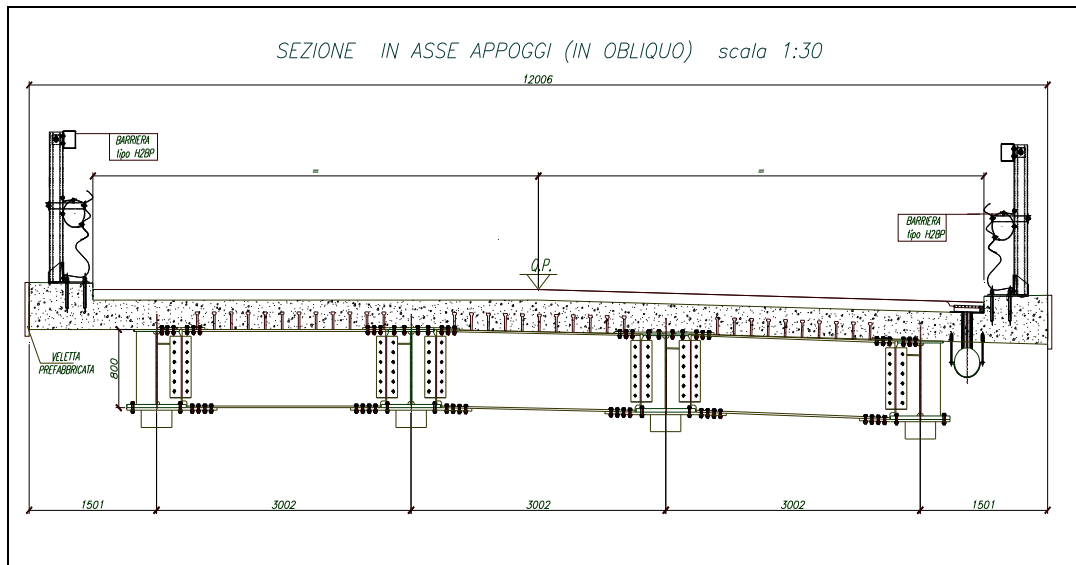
Sezione tipo dell'impalcato Ponte Scolo Buoncambio
